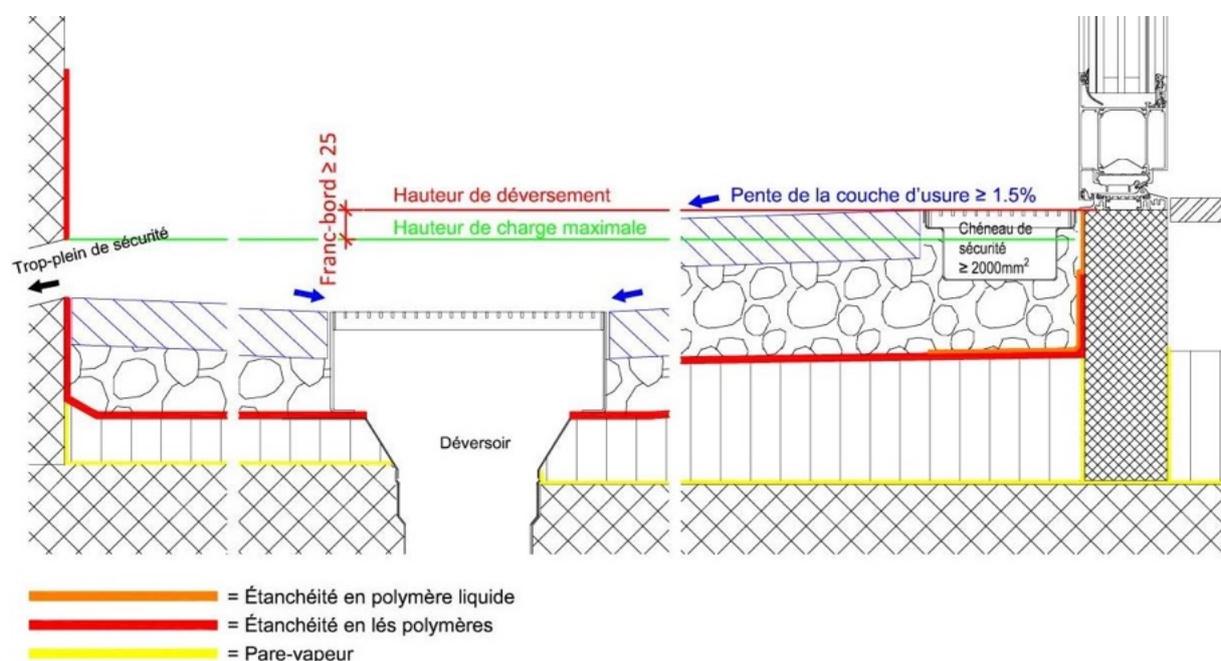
Adaptation de la hauteur du sol extérieur par la construction ultérieure d'une couche d'usure ouverte
